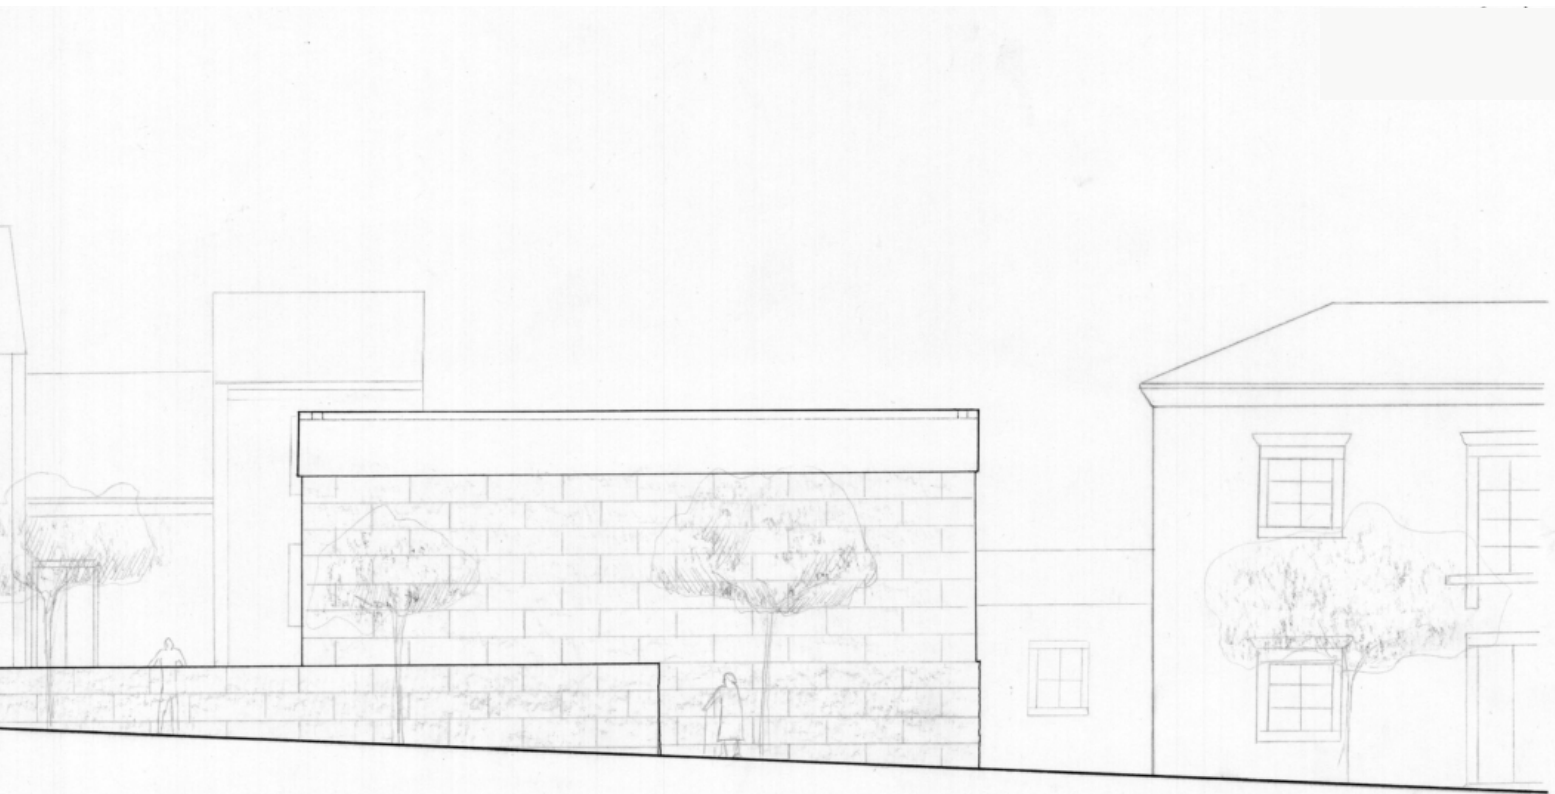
Painel 3 – Alçado sul, escala 1:100.
